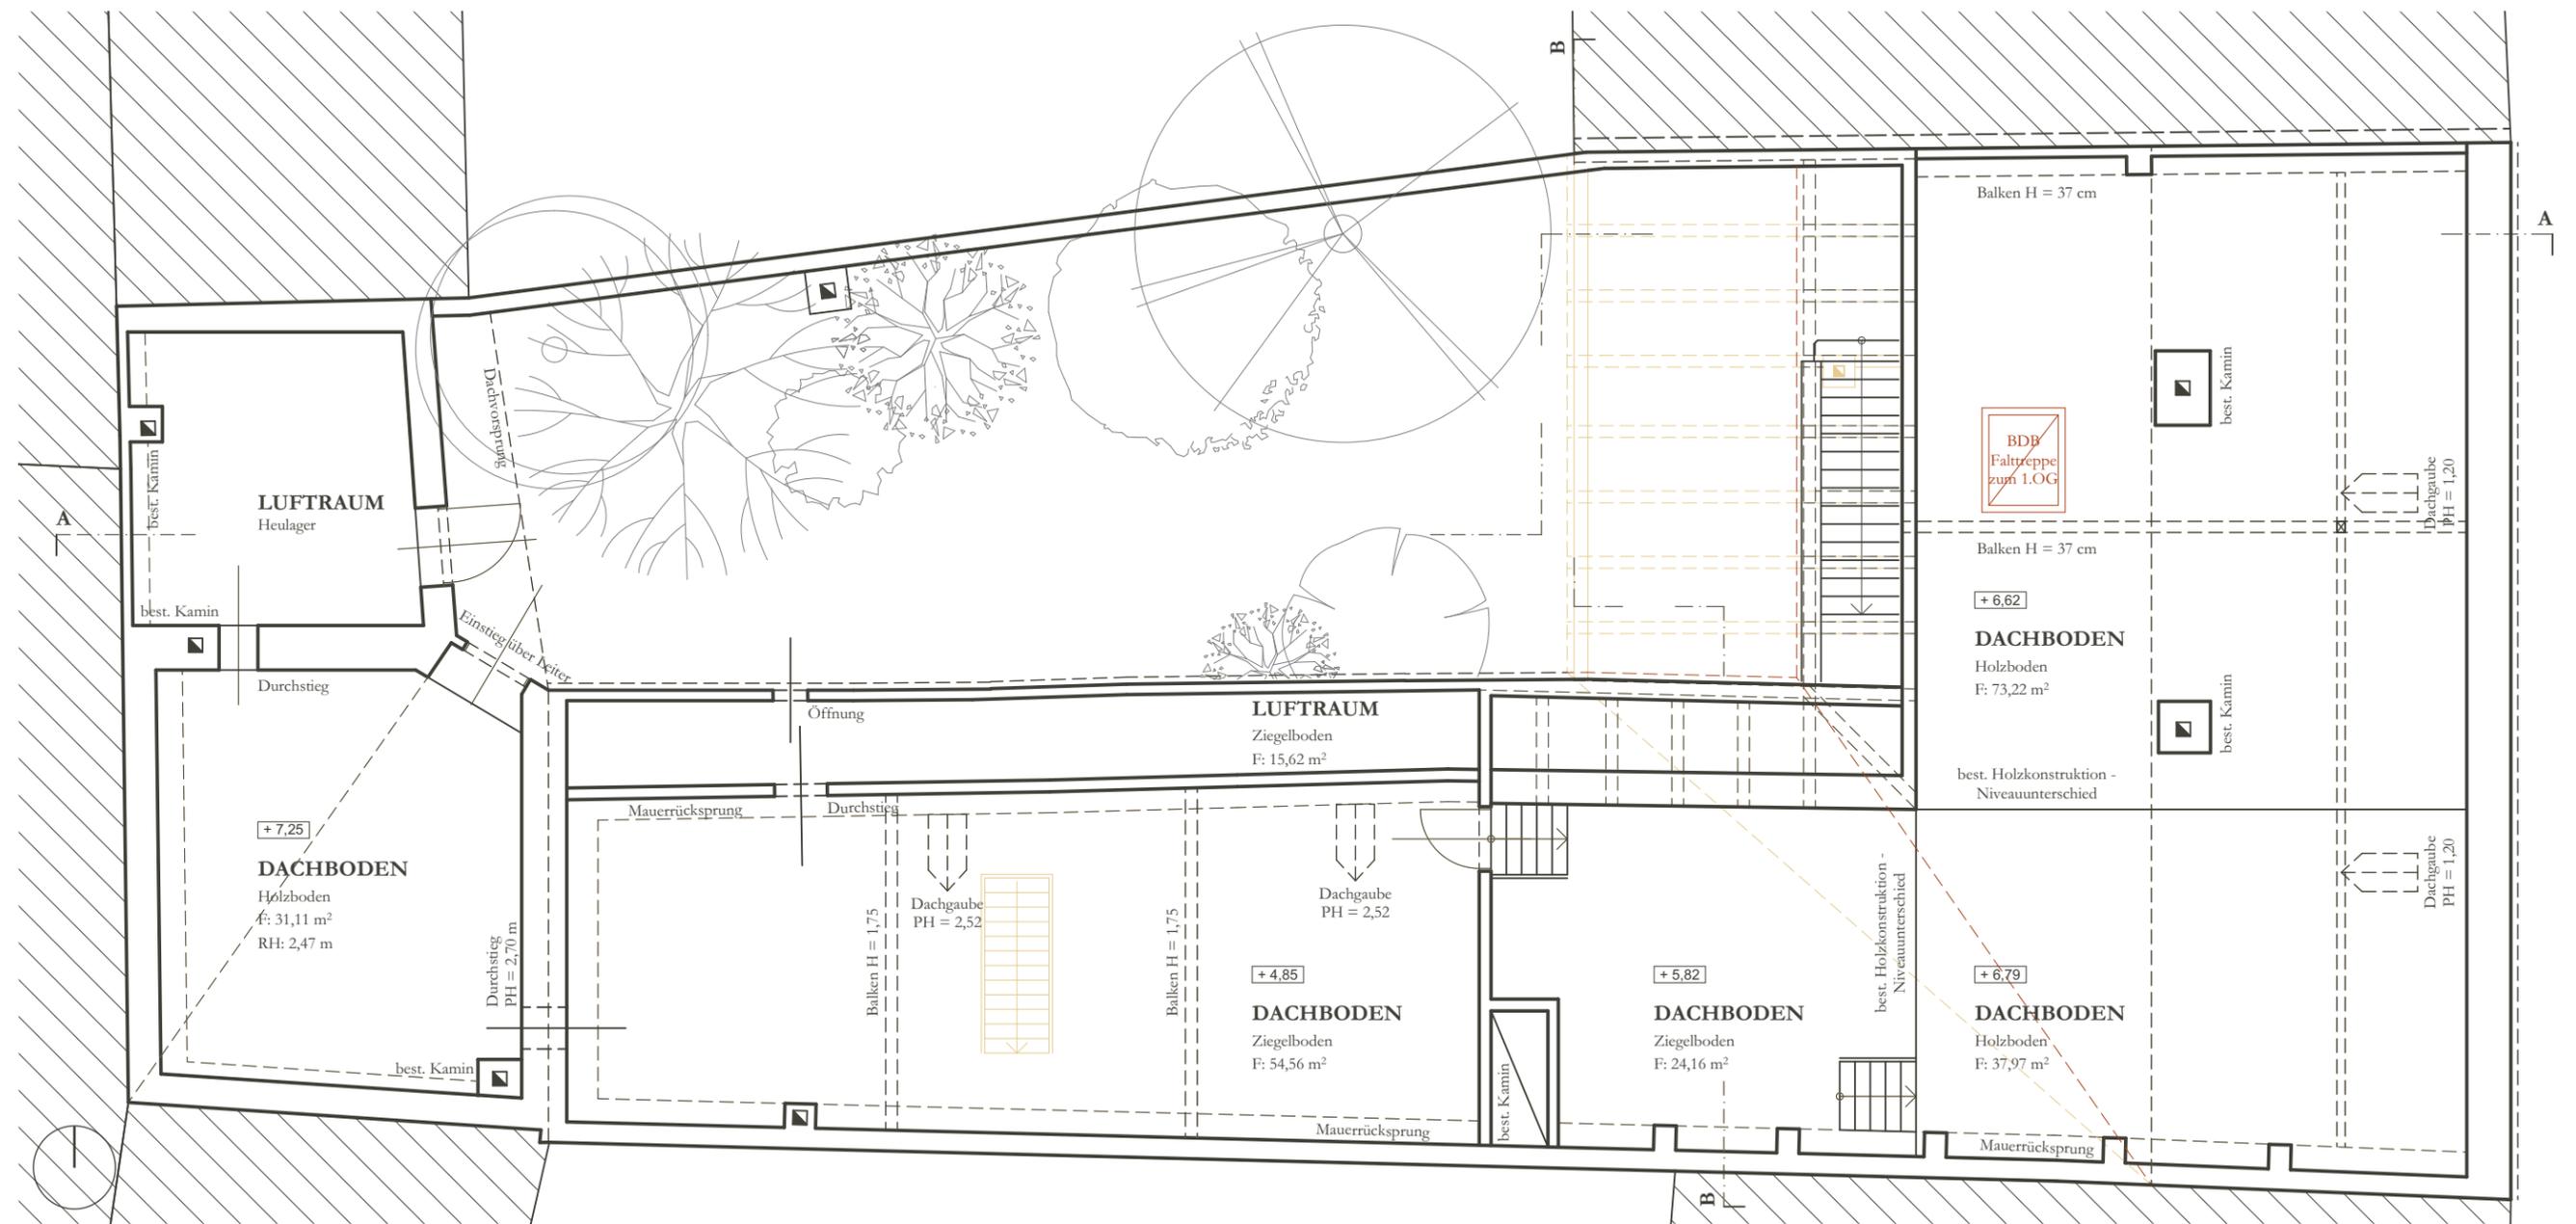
Entwurststudie Dachgeschoss, M 1:100
